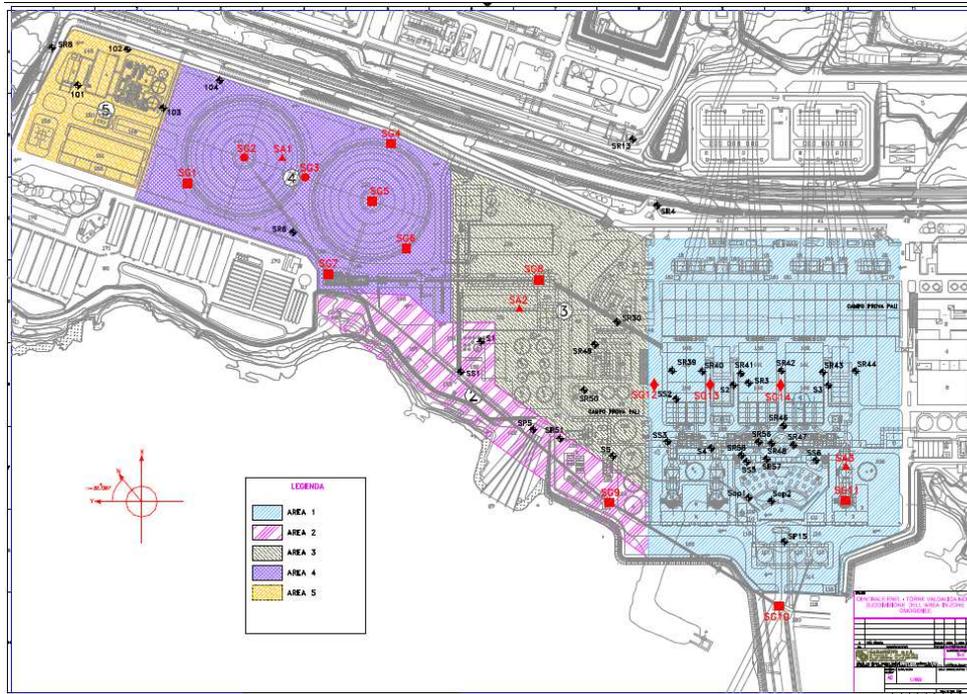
Planimetria con suddivisione in aree geotecniche omogenee
